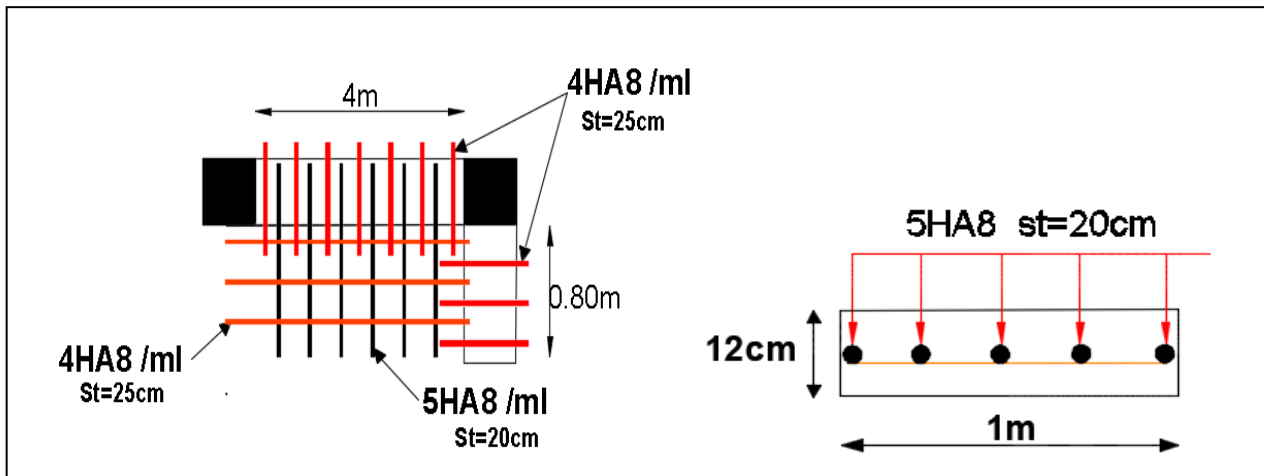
Schéma de ferrailage de la dalle pleine sur deux appuis D1.
